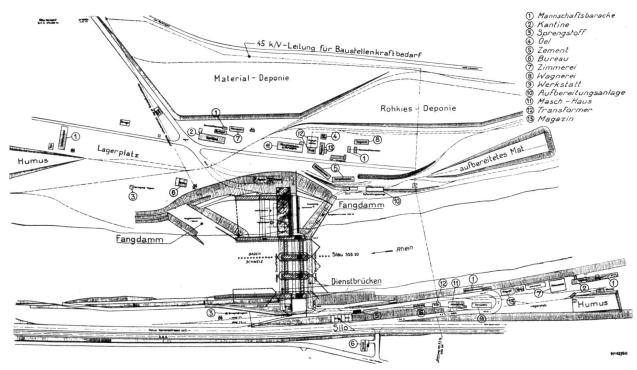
Kraftwerk Reckingen Uebersichtsplan der Bauinstallationen. Maßstab 1:5000 Rot = Caissons der Umrahmung der Krafthausbaugrube.
